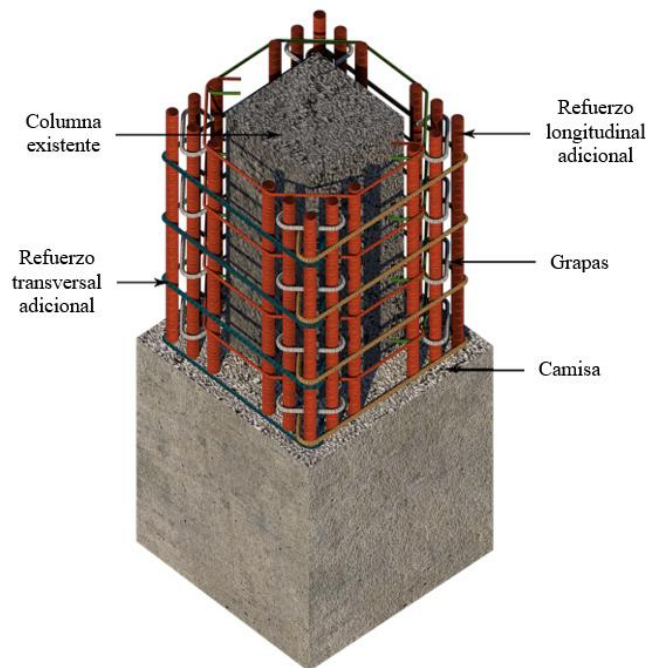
Ejemplo de columna con encamisado de concreto reforzado (INIFED, 2021)
